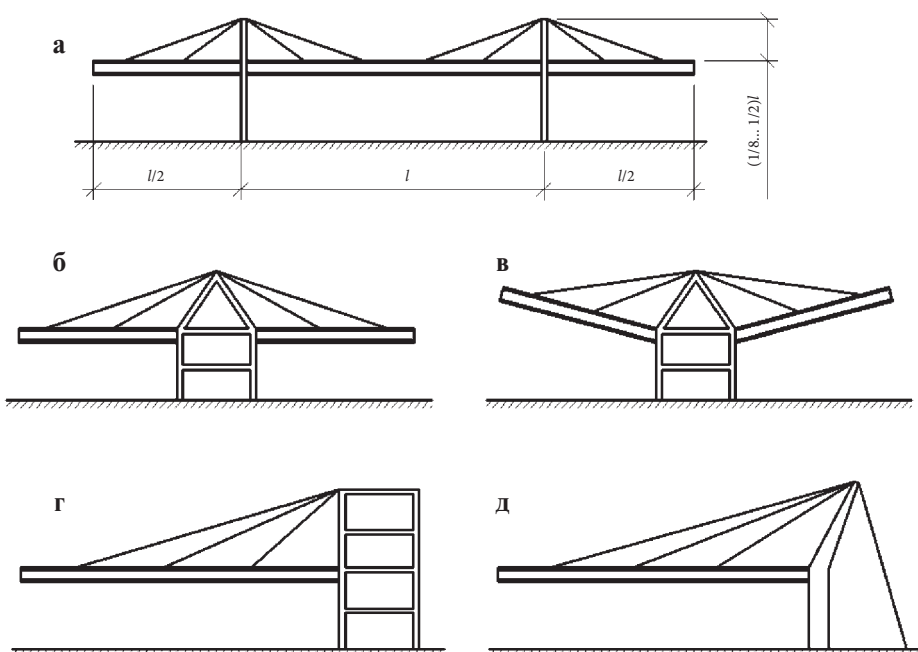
Схемы консольных подвесных покрытий:
